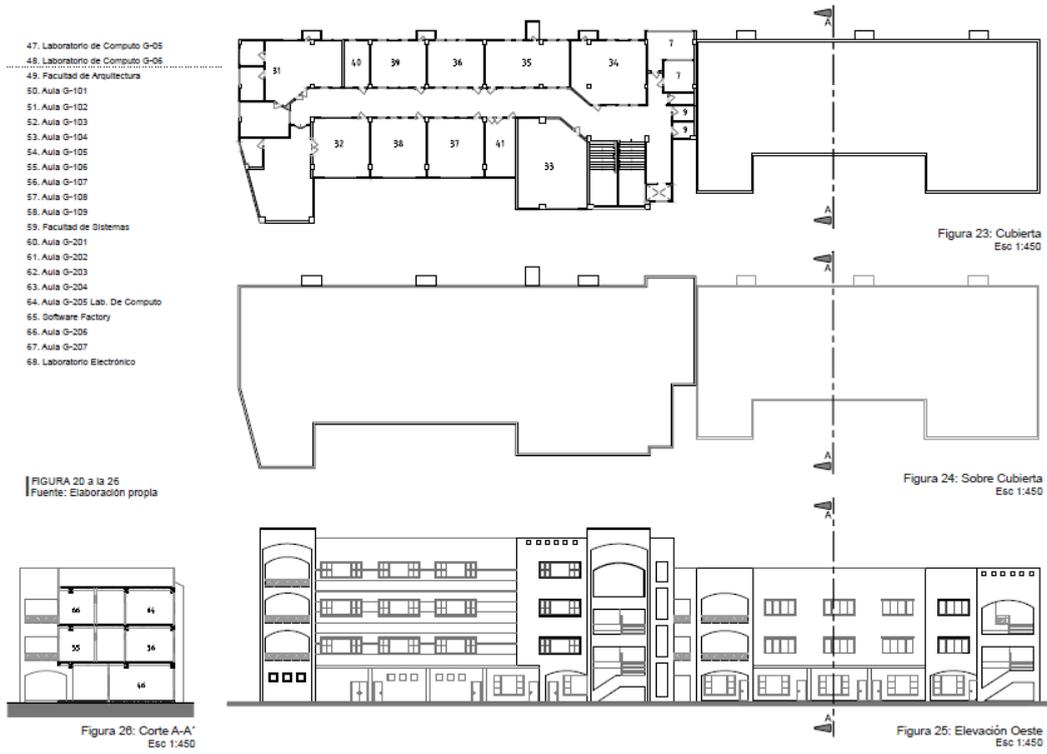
Gráfico 2Vista arquitectónica edificios: F planta 3 y cubierta y G, cubiertas (Rojas, 2013)
